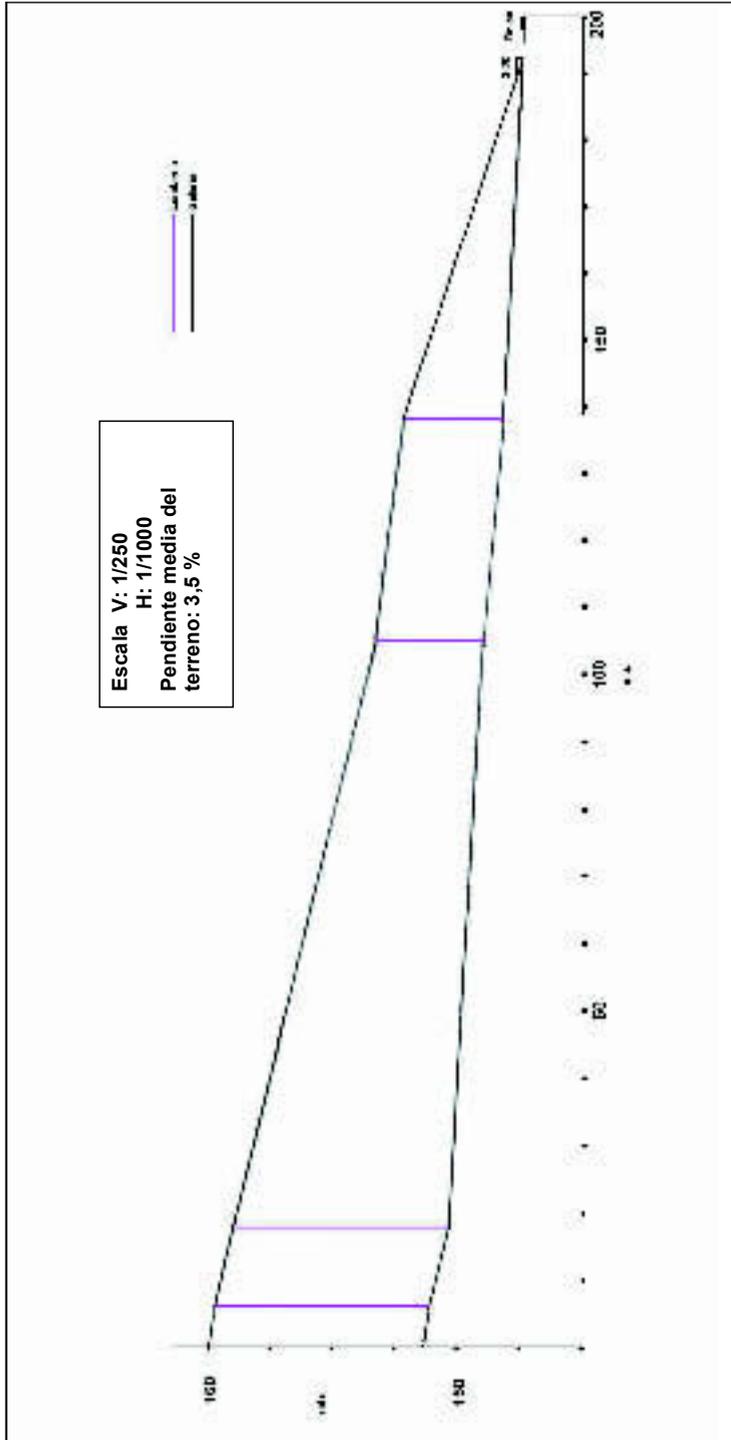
Perfil longitudinal del sistema de la galería con lumbreras de El Cantar.
